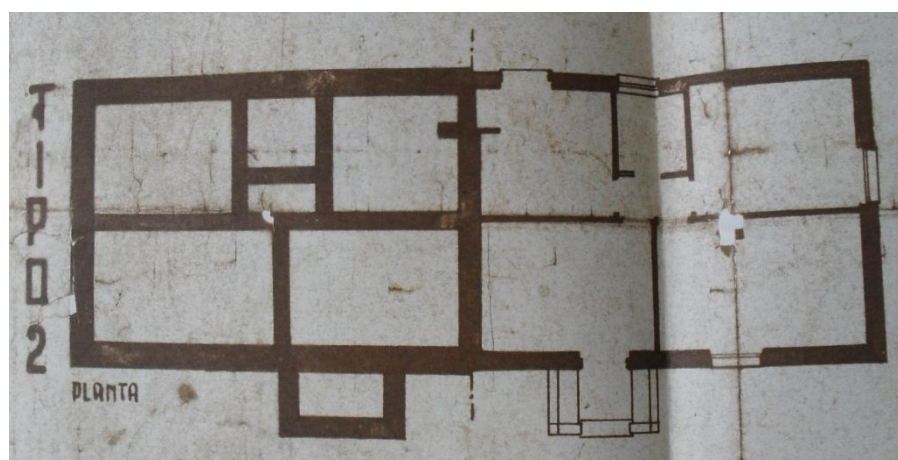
Bairro dos Penedos Altos - Planta, Fonte: Arquivo Municipal
